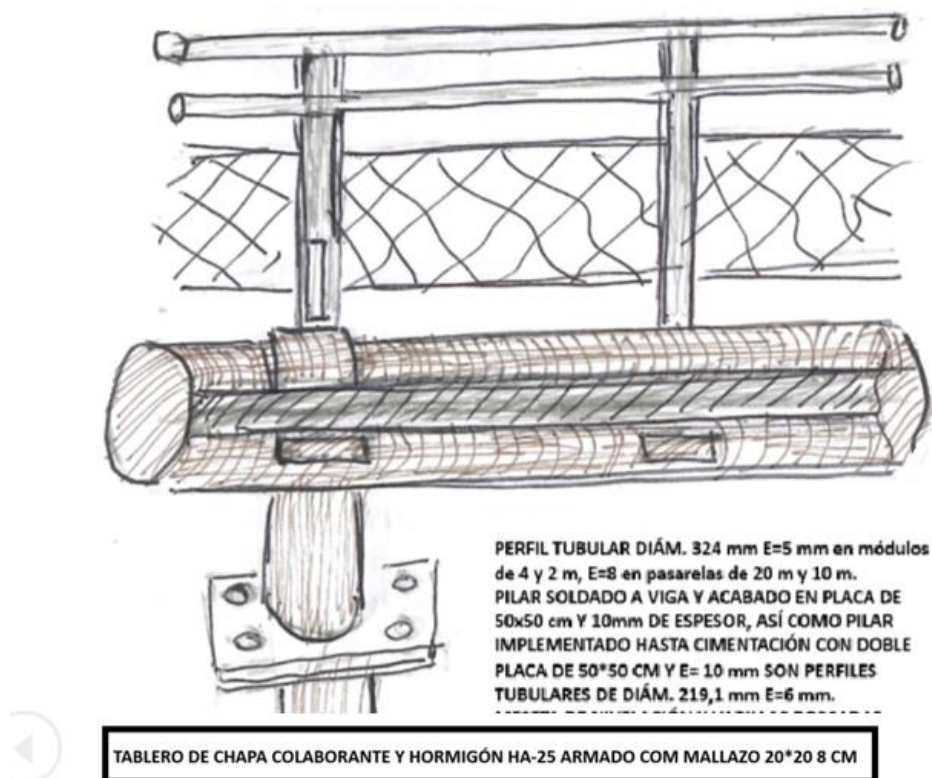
Detalles de los caminos de pasarelas. Concretamente, croquis de la sección estructural e imagen del tablero
